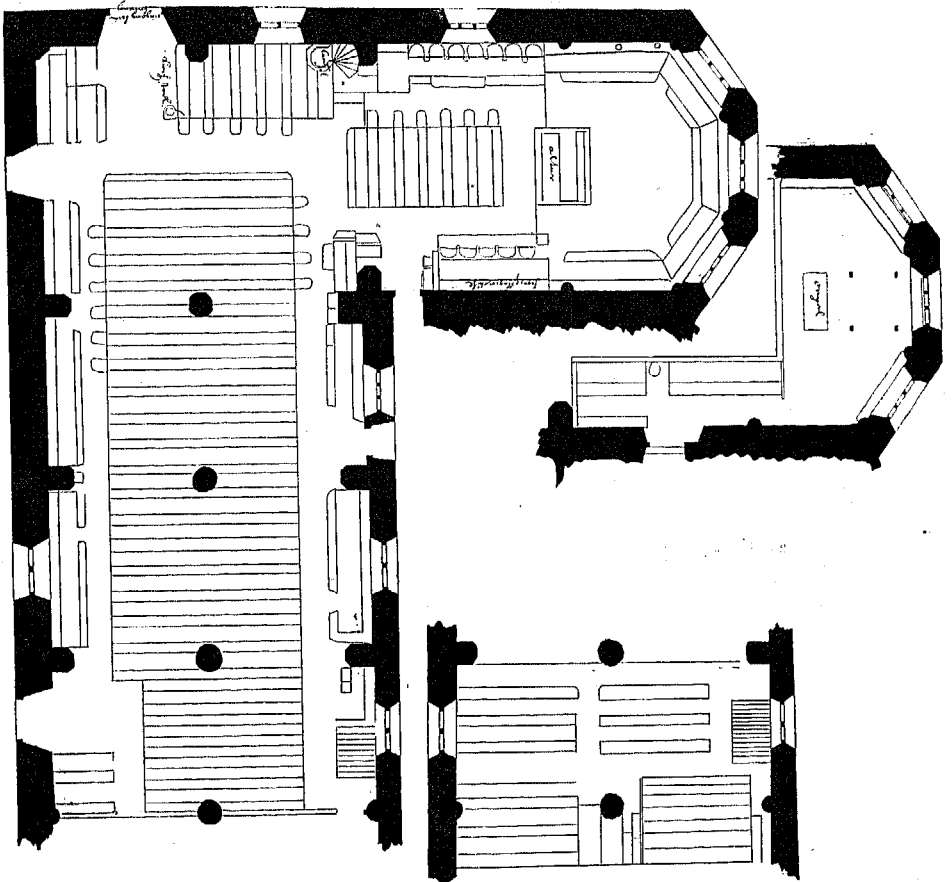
Heiliggeist-Kirche; Grundriss.
